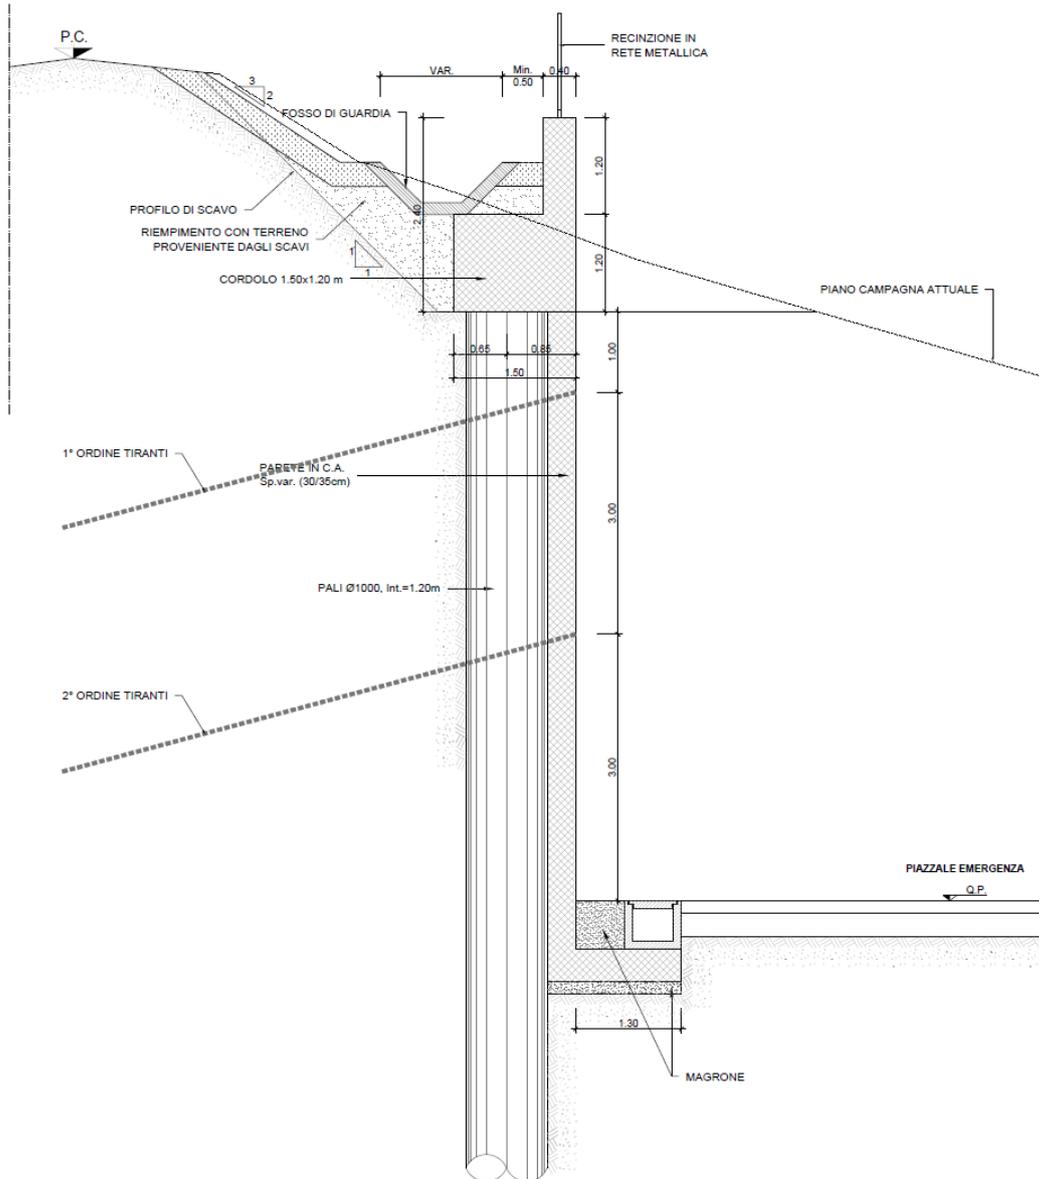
Sezione tipo con paratia tirantata (tipo 2) H>7.5 m
